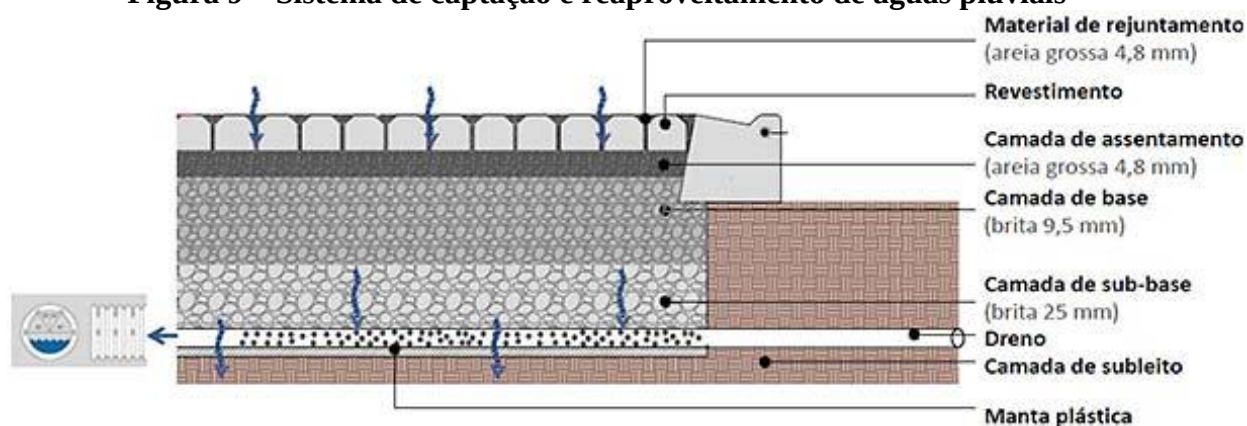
Exemplo de pavimento permeável (intertravamento)
